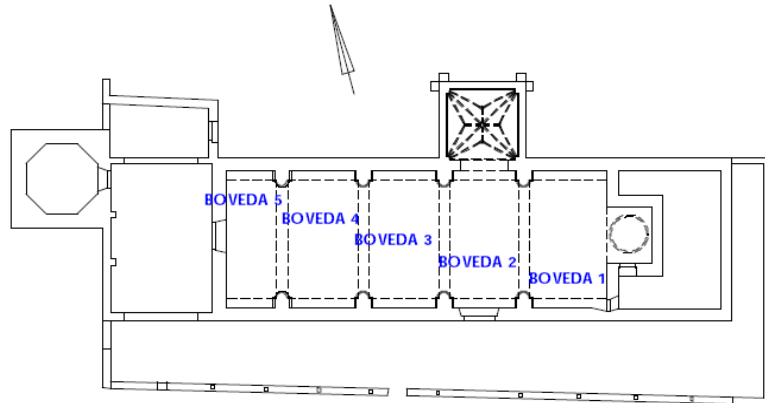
Planta de la Iglesia de San Martín de Arrieta
